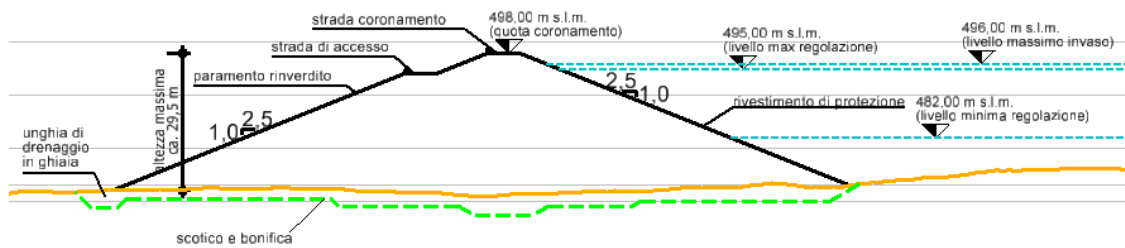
Sezione oggetto di verifica (Sezione H-H).
